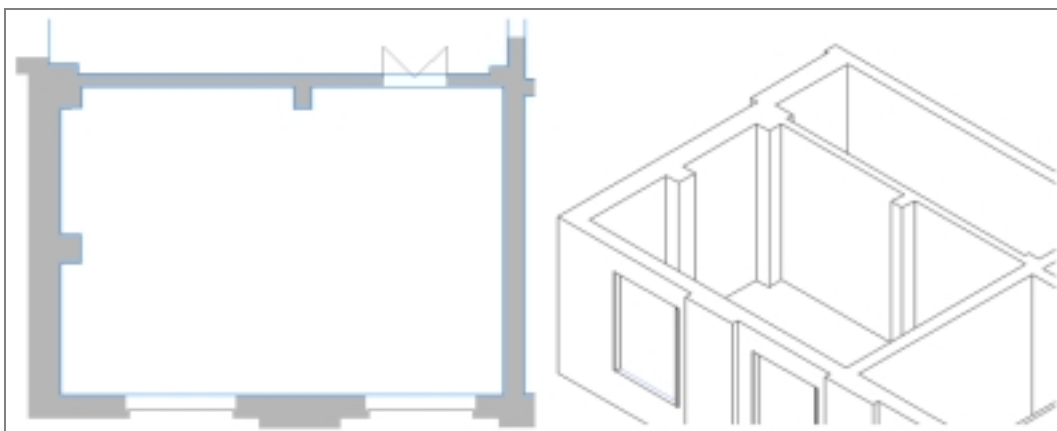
Bauaufnahmemodul – Vor- und Rücksprünge im Wandverlauf als 2D-Planmodifikator in Grundriss (links) und Isometrie (rechts)
